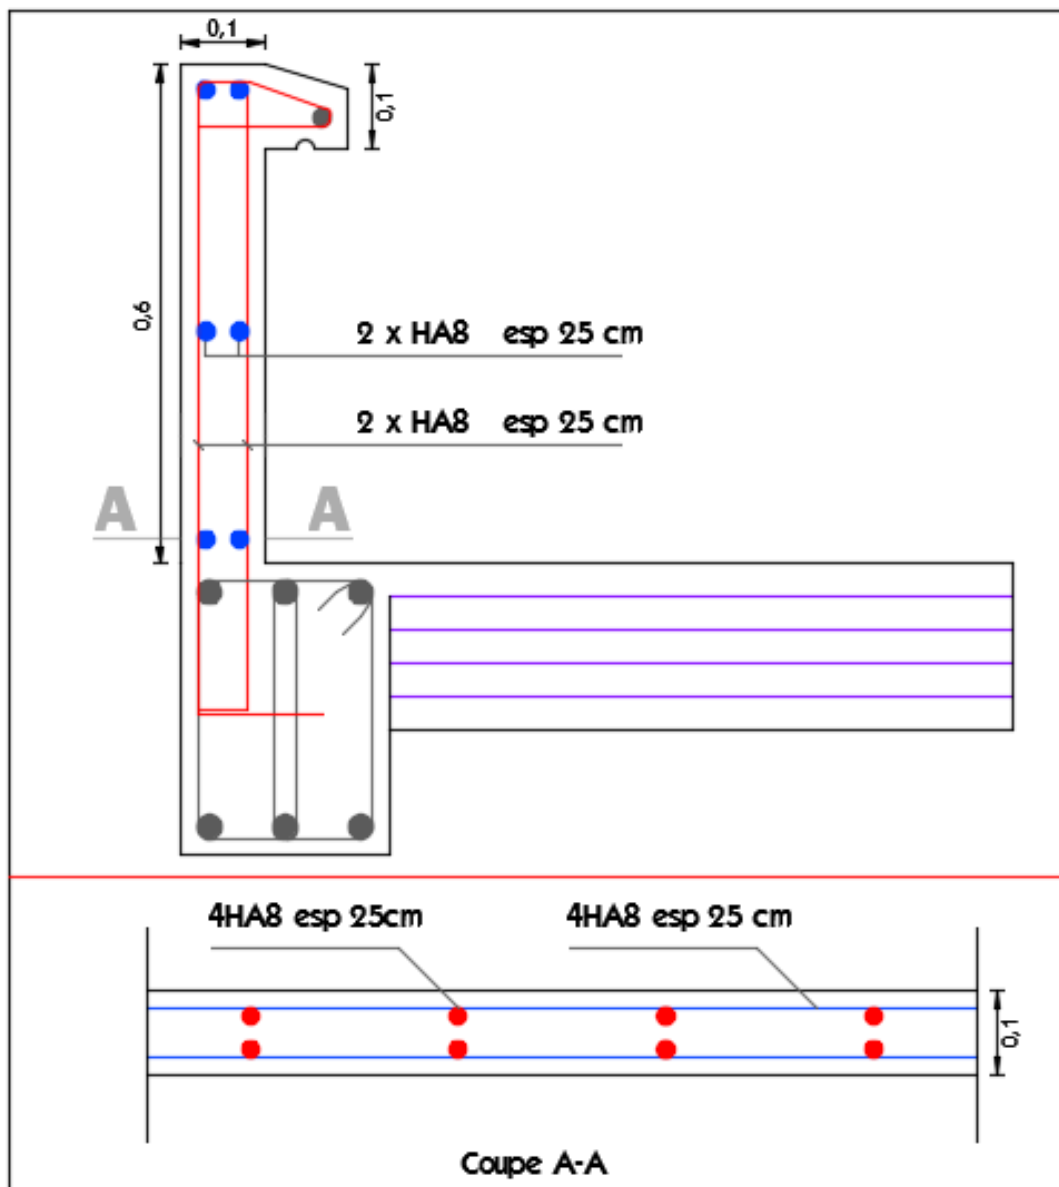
Schéma de ferrailage de l'acrotère[23].
